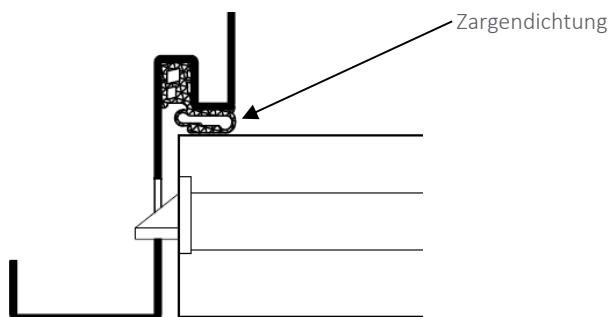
Türblatt stumpfeinschlagend auf Stahlzarge
